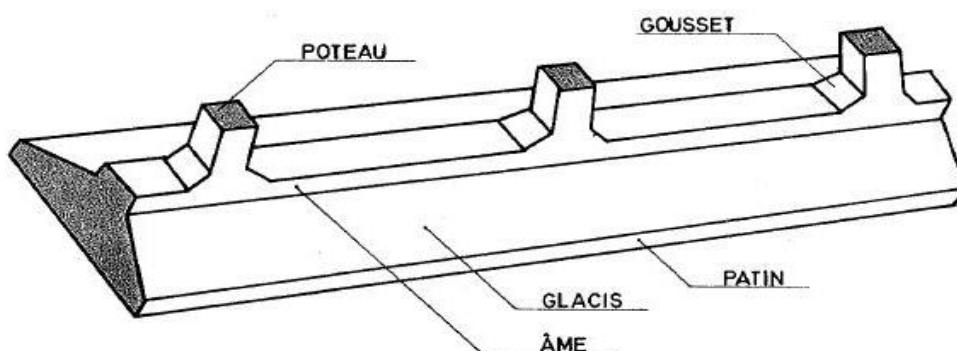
semelle filante sous poteaux (KASSOUL, 2016).
